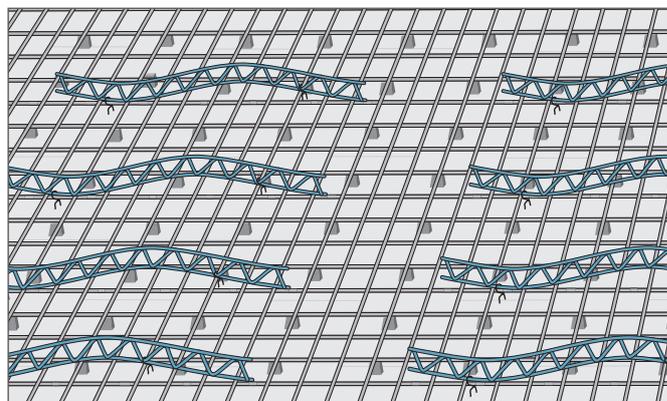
Punto 2 - Montaggio serpentine BKT-S
